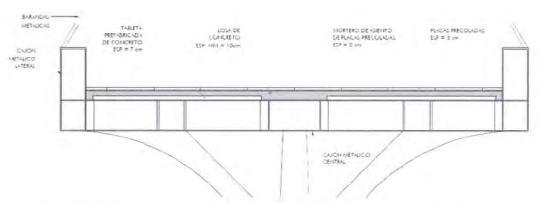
Vista a detalle de corte en que se aprecian la prelosa y losa de la Cazada peatona.
